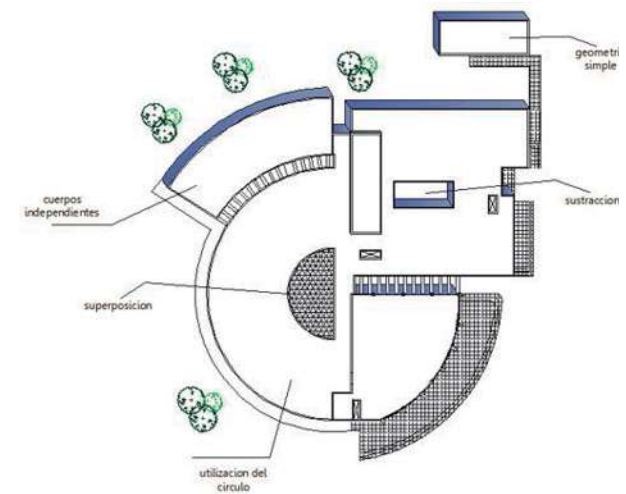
Elementos utilizados en la planta del edificio.
